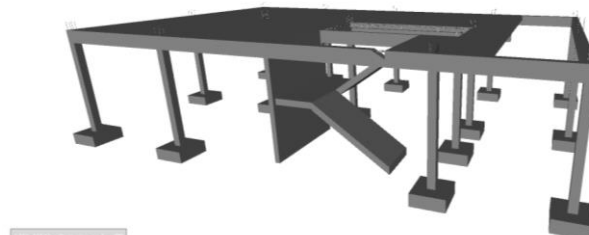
Tarefa de concretagem das vigas e lajes do 1º andar.
